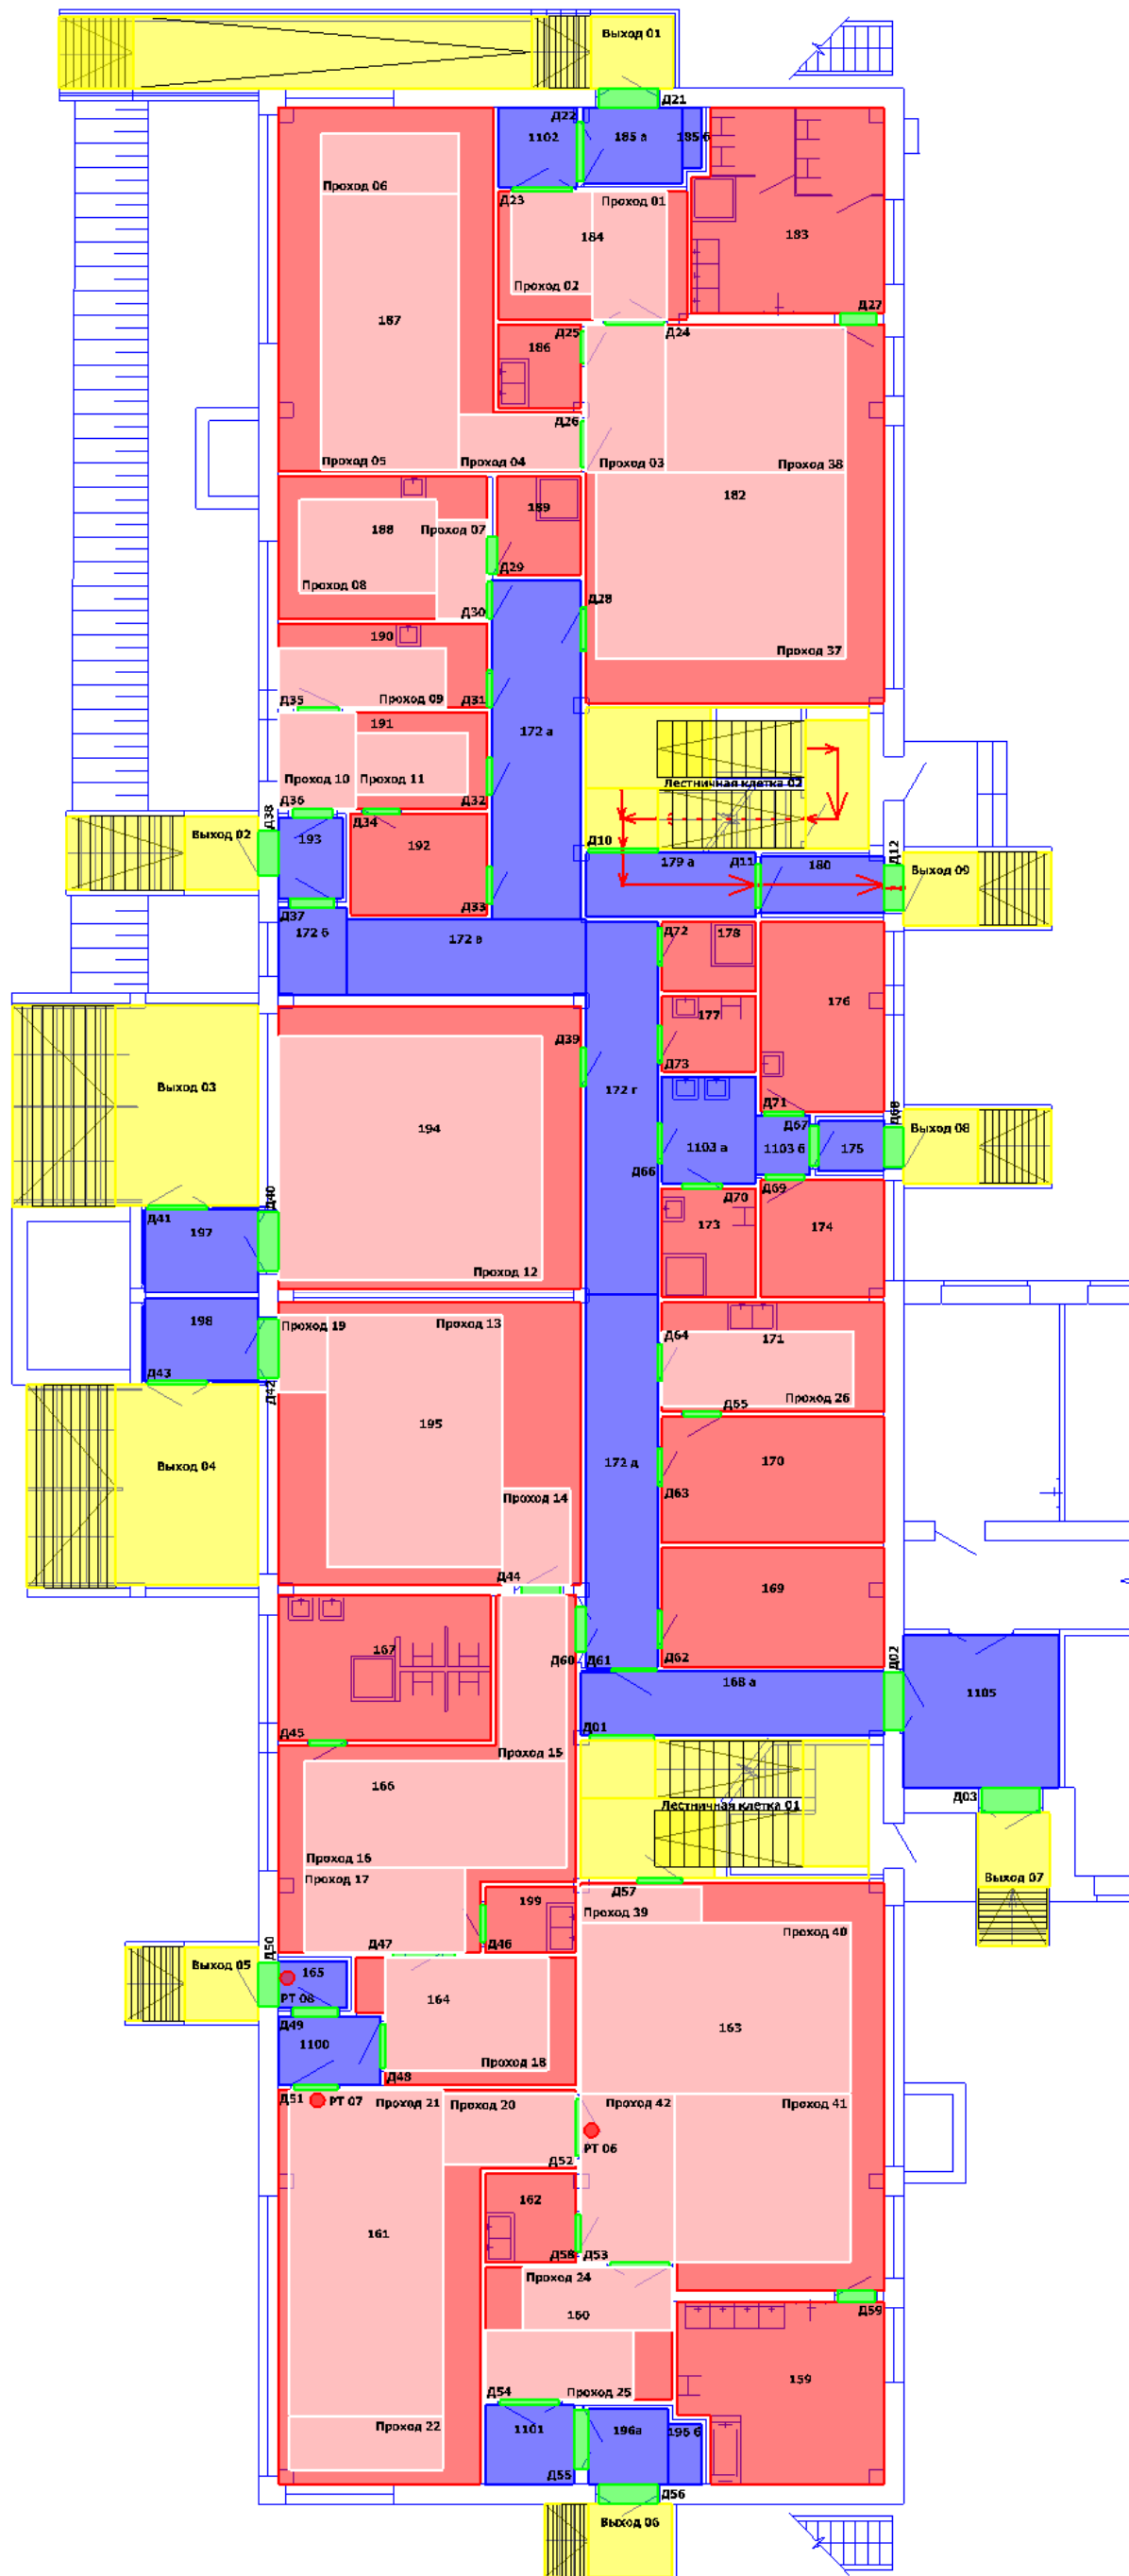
Расчетная схема эвакуации из помещений 1-го этажа здания Детского сада на 60 мест с начальной школой на 100 учащихся (Сценарий 02)
